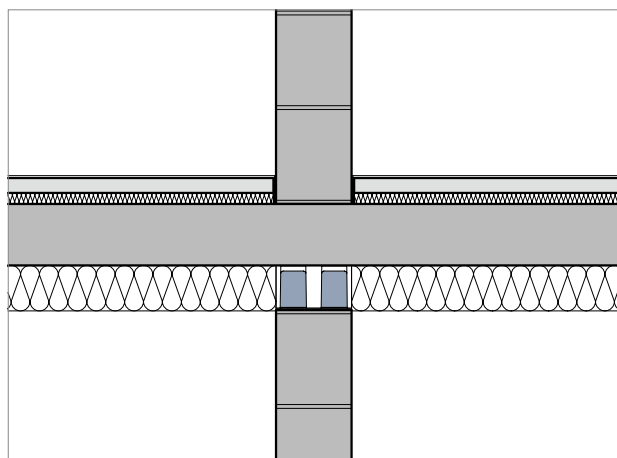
Napojení s detailním modelem prvku Schöck Sconnex®
